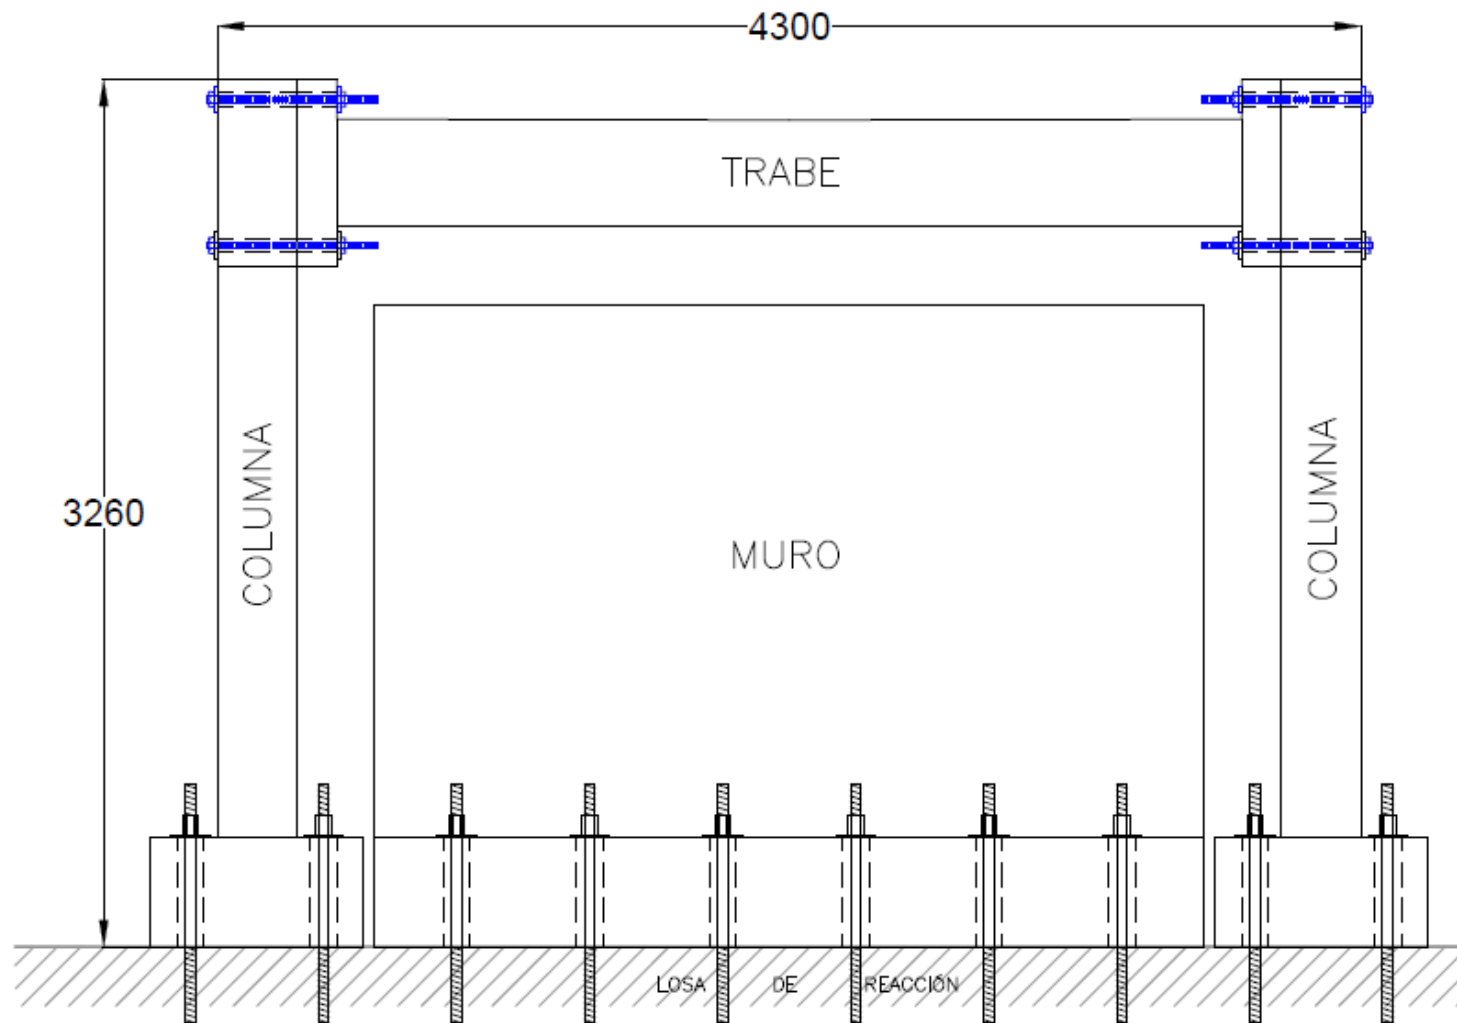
Configuración marco-muro con dimensiones en milímetros.
